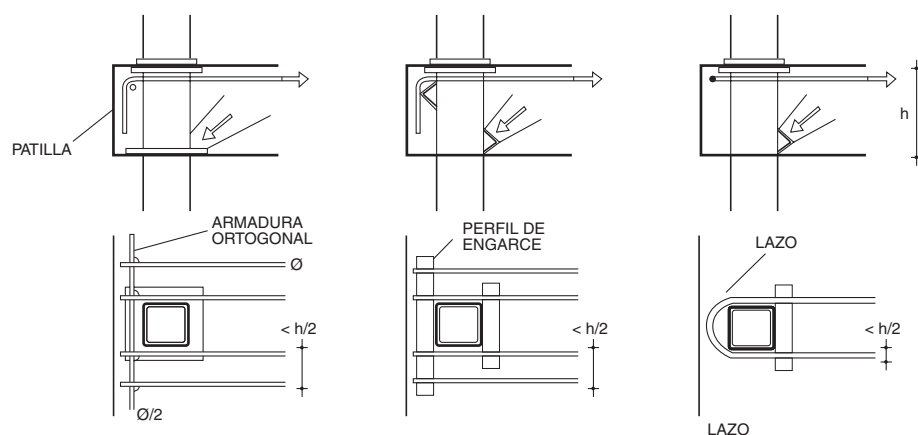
Armaduras superiores en nudo extremo con soporte metálico
